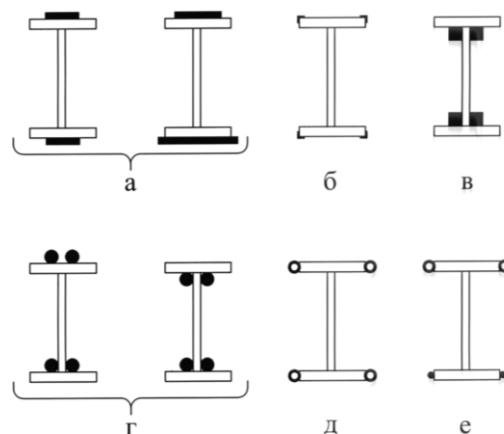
Усиление стальных балок симметричными накладками из: а – полосовой стали; б – уголков; в – квадрата; г – круглой стали; д – труб; е – комбинацией проката
